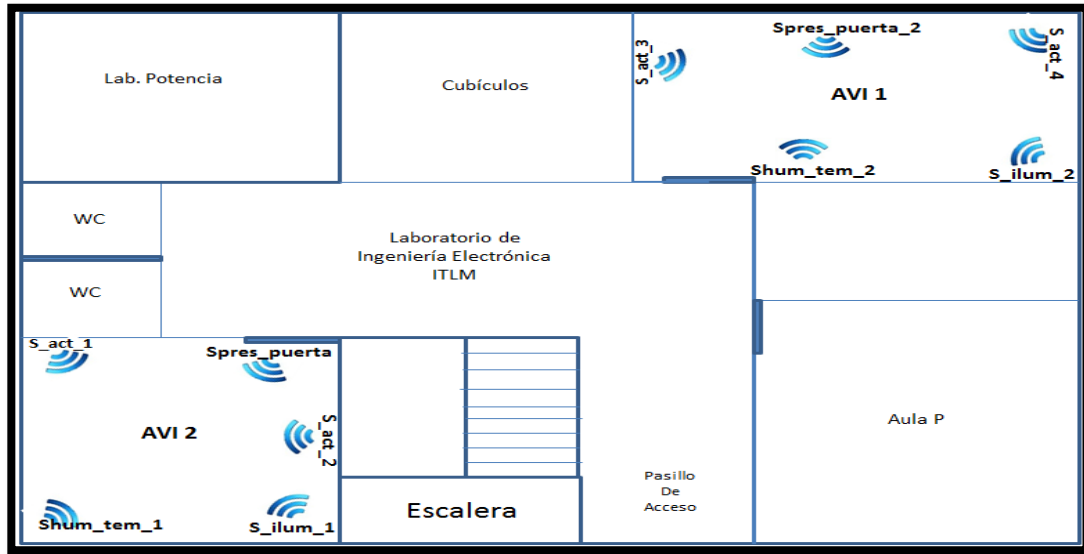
Vista arquitectónica de la planta del recinto de prueba.
